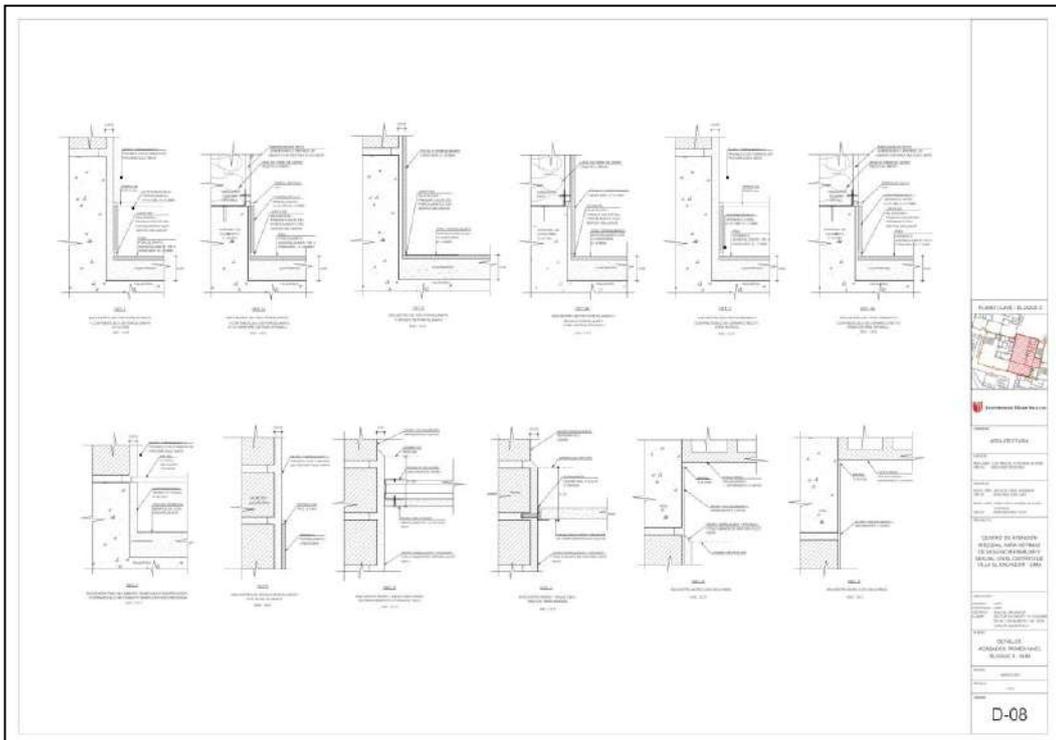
Detalles de acabados en zona SUM primer nivel – bloque 2.
